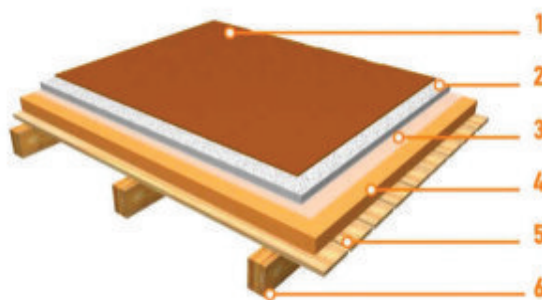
Полы первого этажа над вентилируемым подпольем: 1 – верхнее покрытие пола (плитка); 2 – цементно-песчаная стяжка; 3 – пароизоляция; 4 – пеноплекс; 5 – деревянные доски; 6 – балки
